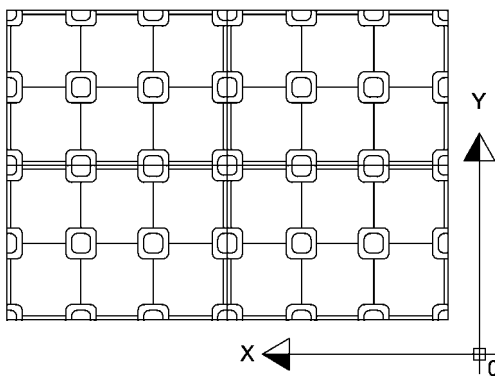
Montaje en planta de las piezas Cáviti®. Sentido de colocación de las piezas.
